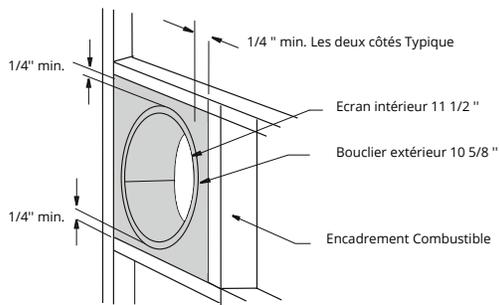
Installation du RHS102. (Installer en glissant sur le tuyau d'évent où il passe à travers la construction combustible).
